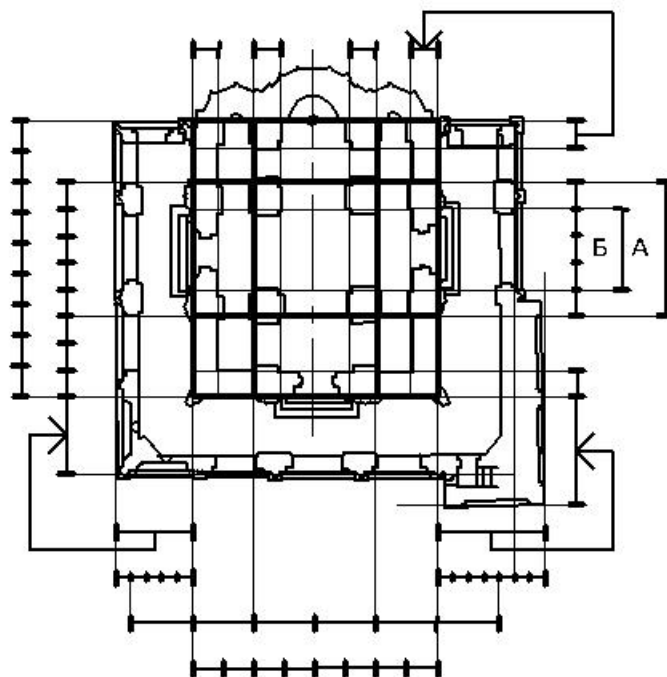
Разбивка плана на строительной площадке и определение дополнительных размеров.
